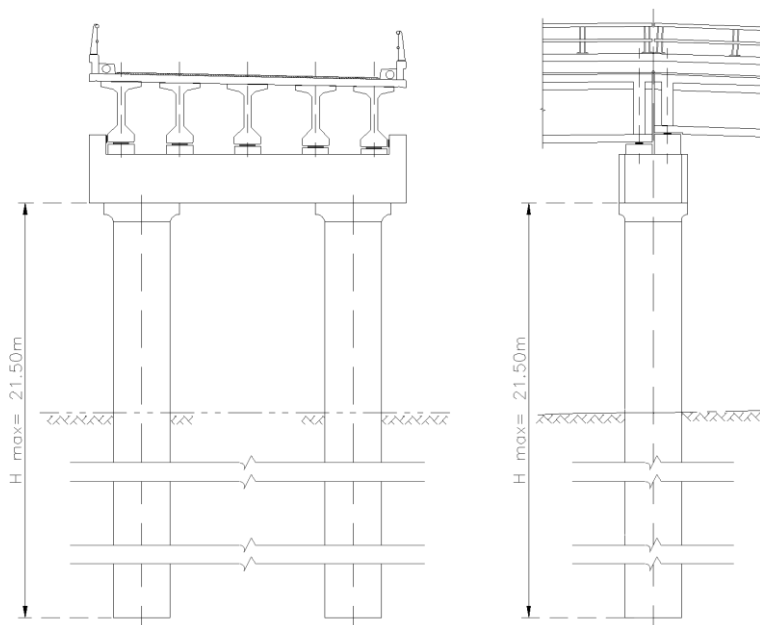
Sección tipo de apoyo intermedio no. 2 al 7.
